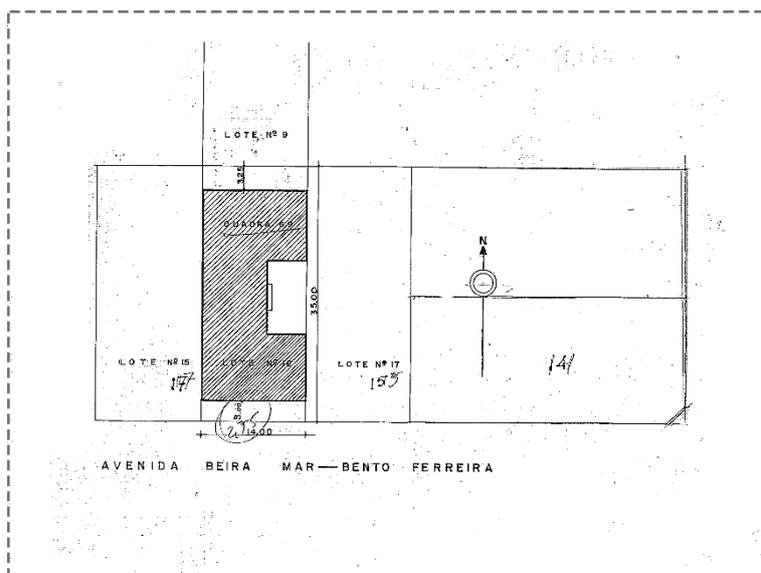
Detalhe Planta de implantação do Ed. Nice.
